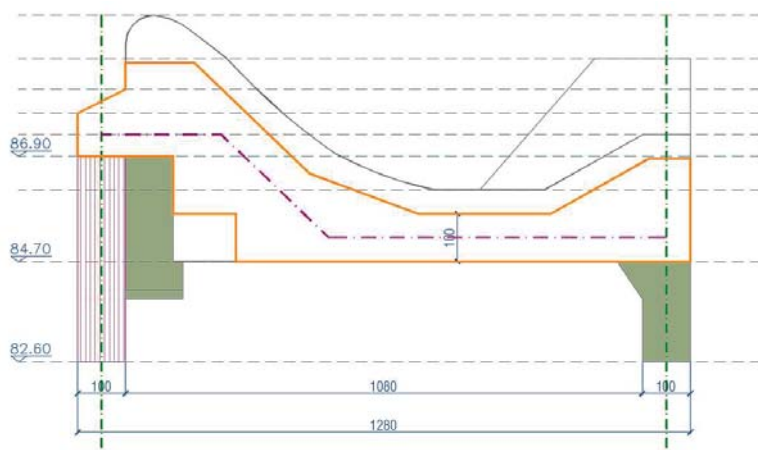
Planimetria delle diaframature di fondazione da progetto 1996 – Tavola 46
